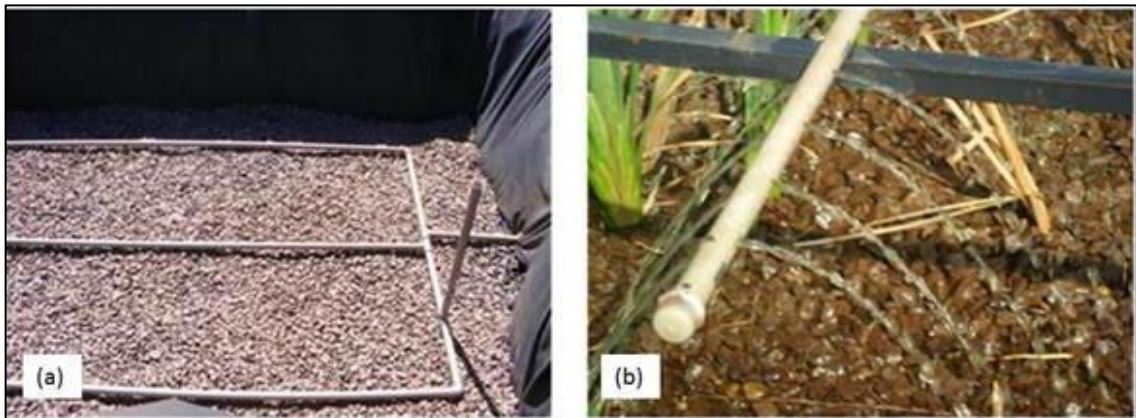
Tubulações do FPMV. a) tubulação de coleta/drenagem; b) tubulação de alimentação.
